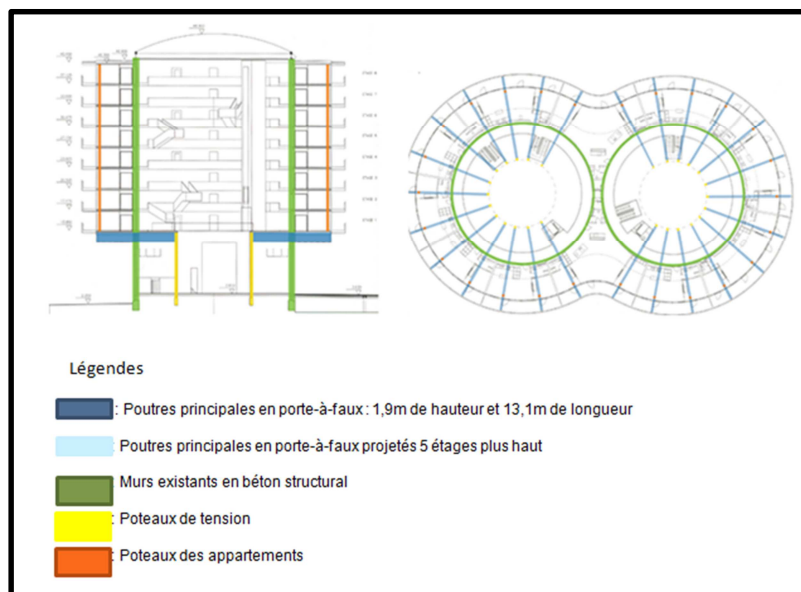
coupe et plan de la structure du projet, source : Etude d'une pensée constructive d'architecte, Gemini résidence
